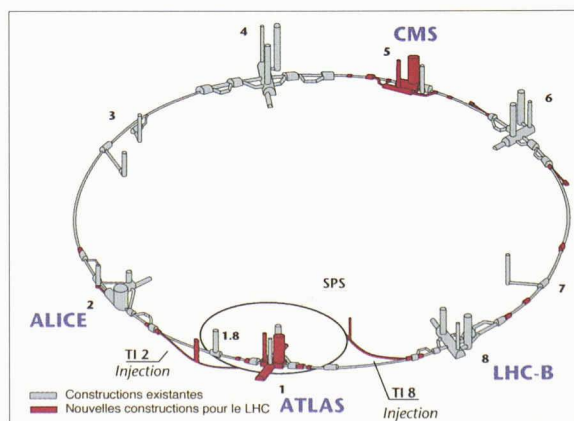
Plan du tunnel du LEP avec les nouvelles constructions pour le LHC (Source : CERN)
